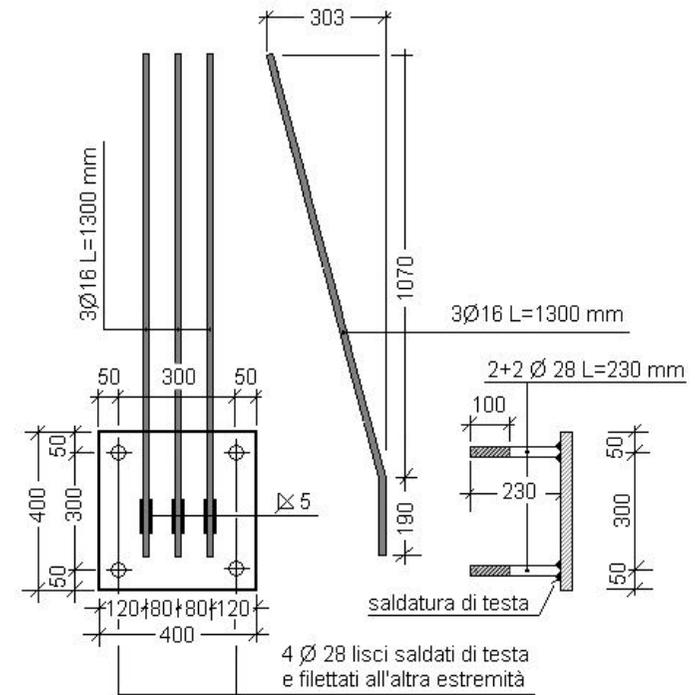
Nodo parete-trave di acciaio: trave bassa.
